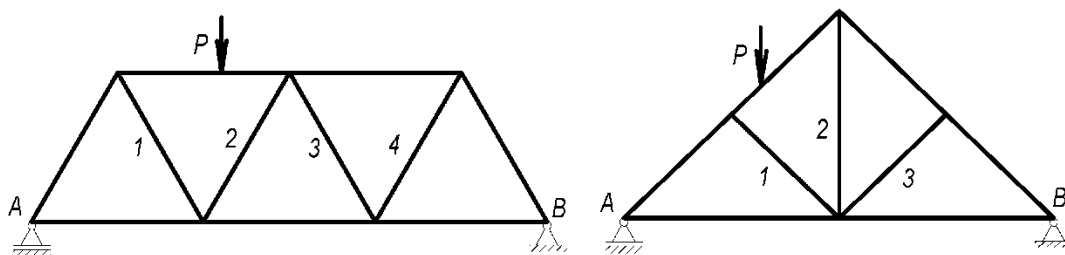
Расчетные схемы металлической и деревянной ферм
